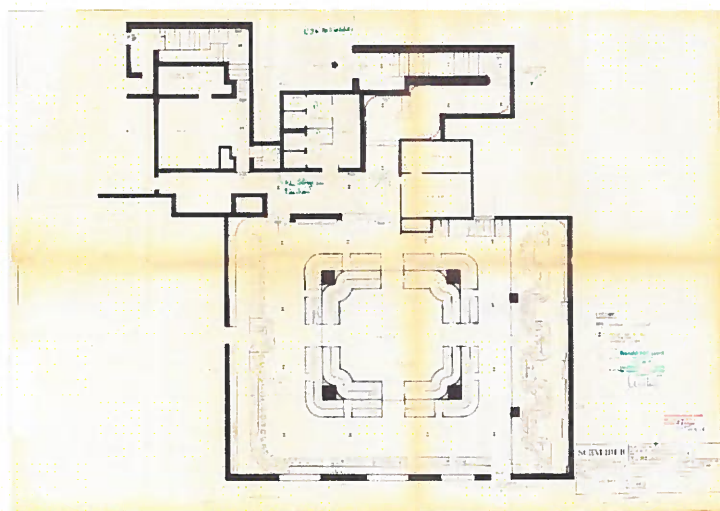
Antragsplanung: Umgestaltung „big apple“, Bauakte Stadt Wiesbaden
